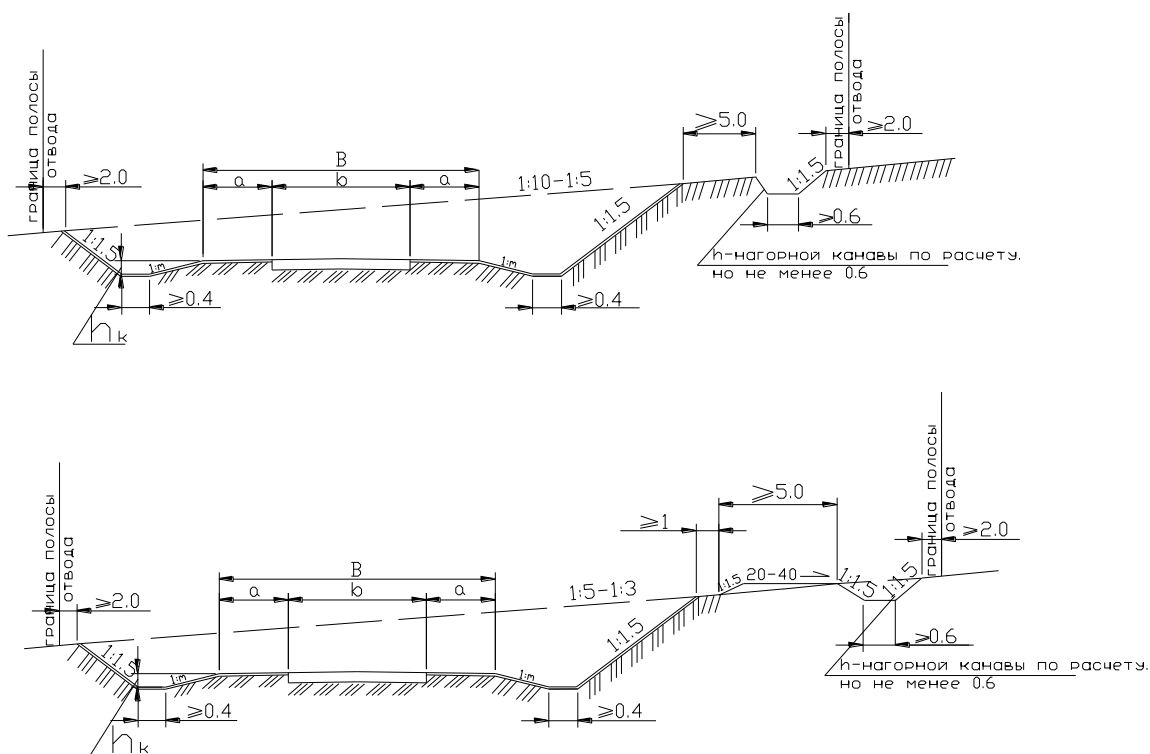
Поперечный профиль земляного полотна в выемке на косогорах: а) крутизной от 1 : 10 до 1 : 5; б) крутизной от 1 : 5 до 1 : 3.
